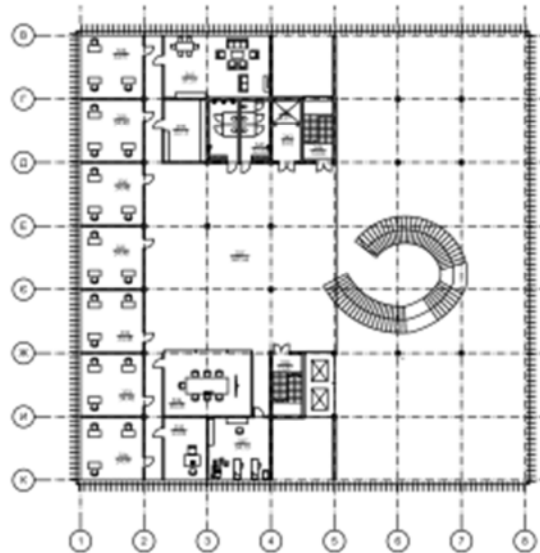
План 3-го поверху на відмітці 8.700 м
